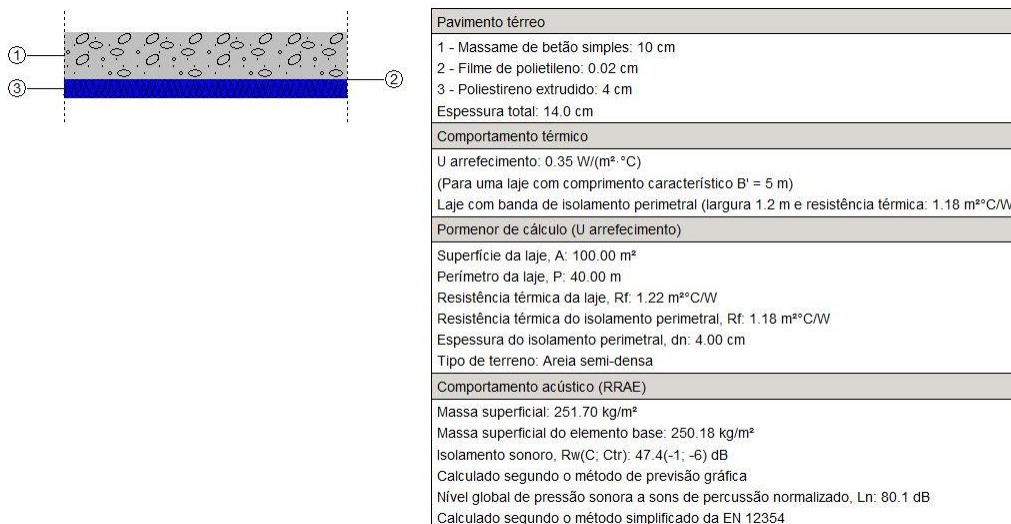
11 Modelo do pavimento térreo (Adaptado do Software CYPE Ingenieros)
